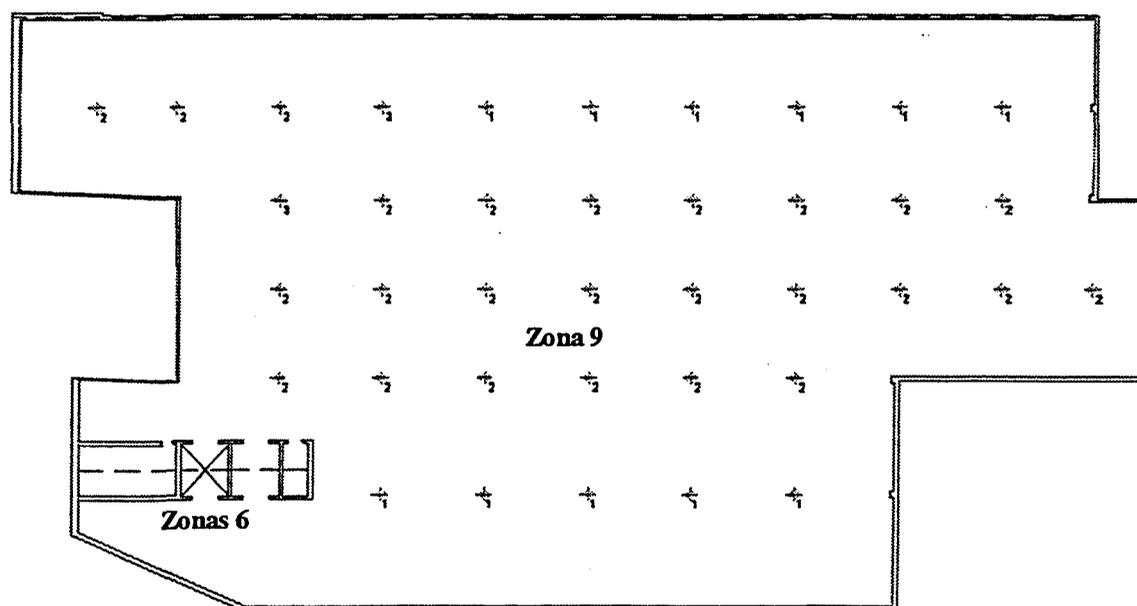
Planta general de las zonas de tintorería e hilatura
